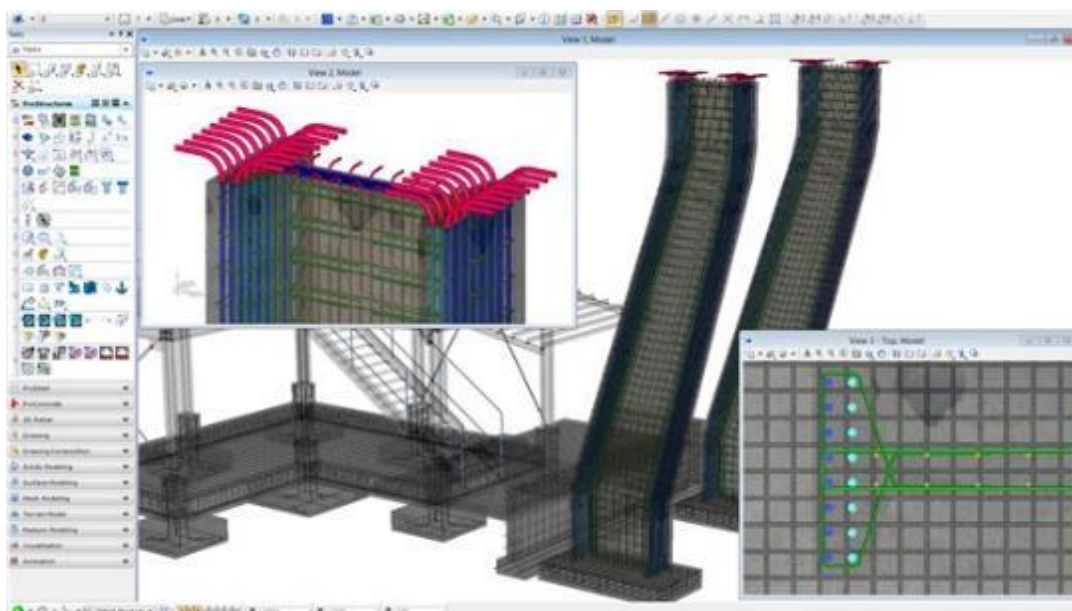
ProConcrete, interface e exemplo de modelação de armaduras
